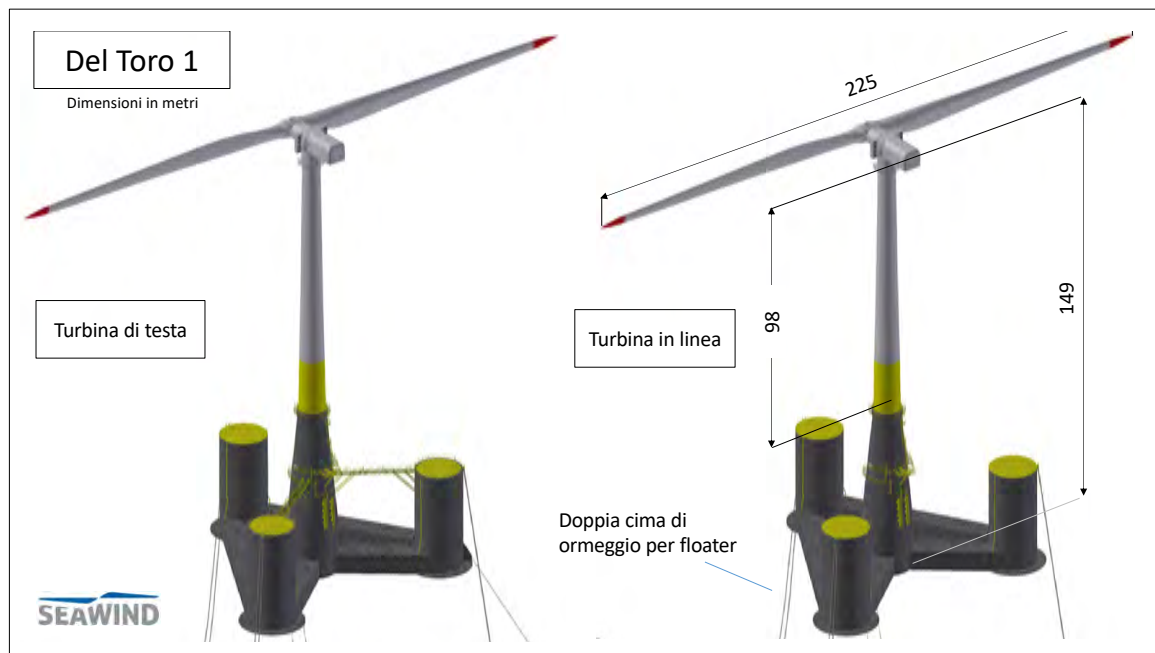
Turbina di testa e di linea mod. Seawind 12 – ingombri e dimensioni
